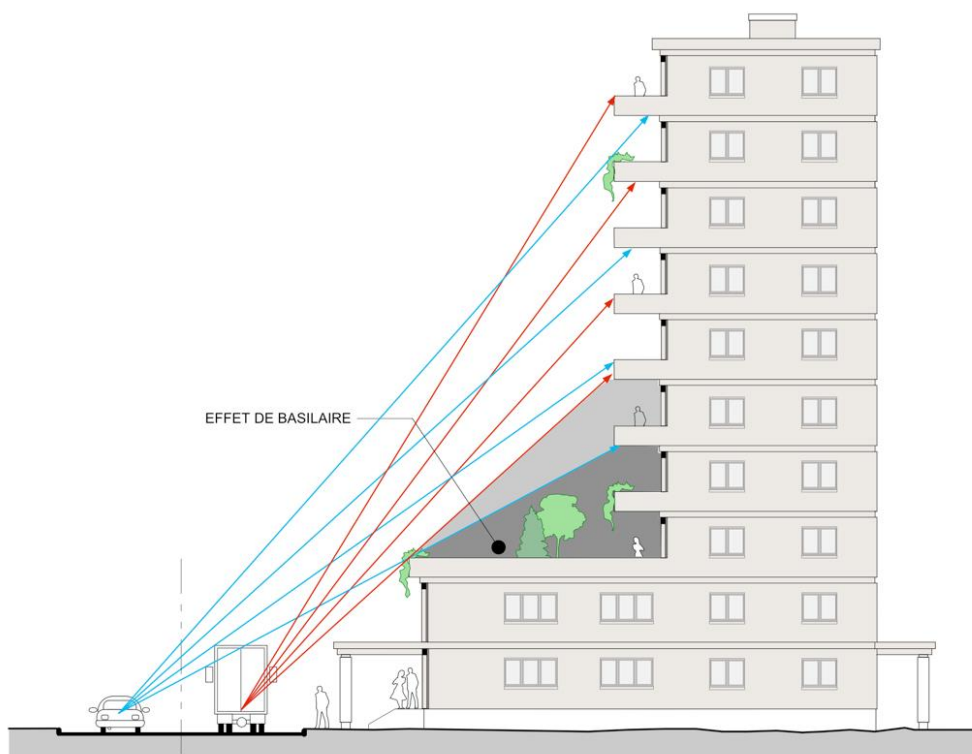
a : Protection d'un immeuble en hauteur à l'aide d'un basilare
